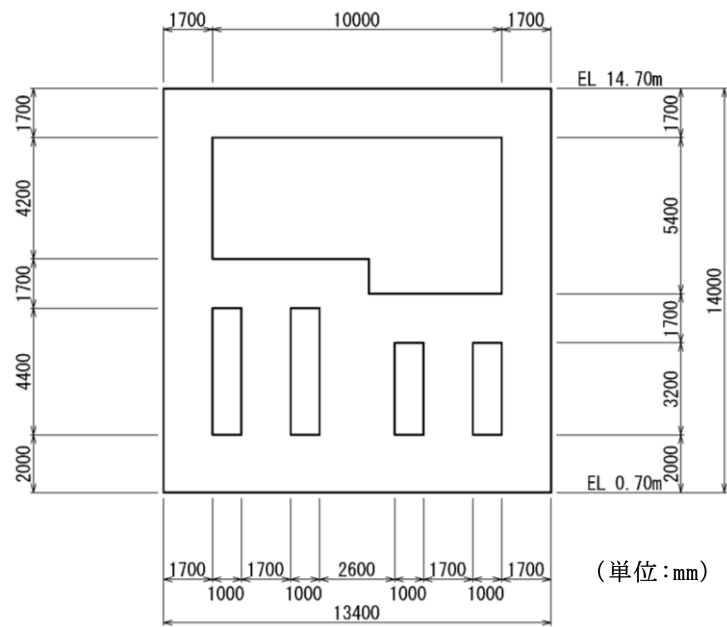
第 1 ベントフィルタ格納槽 断面図 (B-B 断面)
